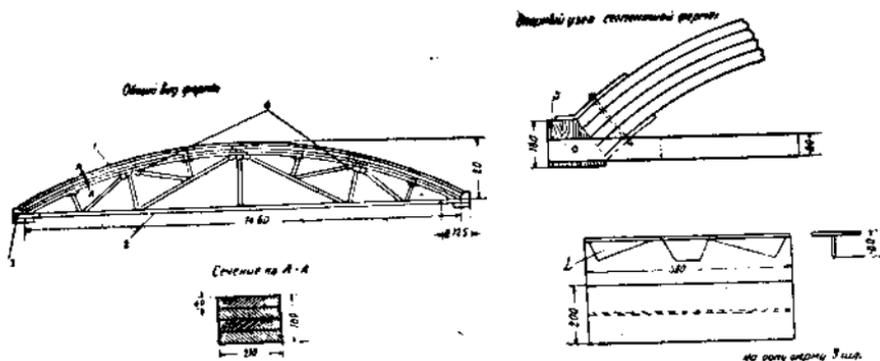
Сегментная комбинированная ферма: 1—верхний пояс; 2—нижний пояс; 3—башмак; 4—соединительные части (поковки).
